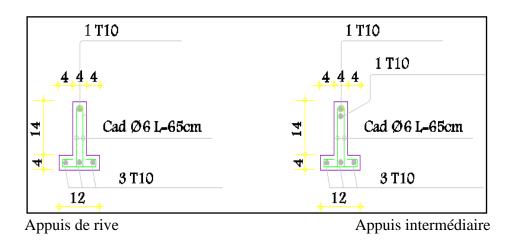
Dessin de ferraillage des poutrelles des étages courants.
